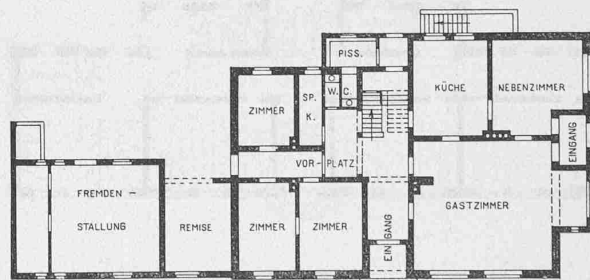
Erdgeschoss-Grundriss. — Masstab 1 : 400.
